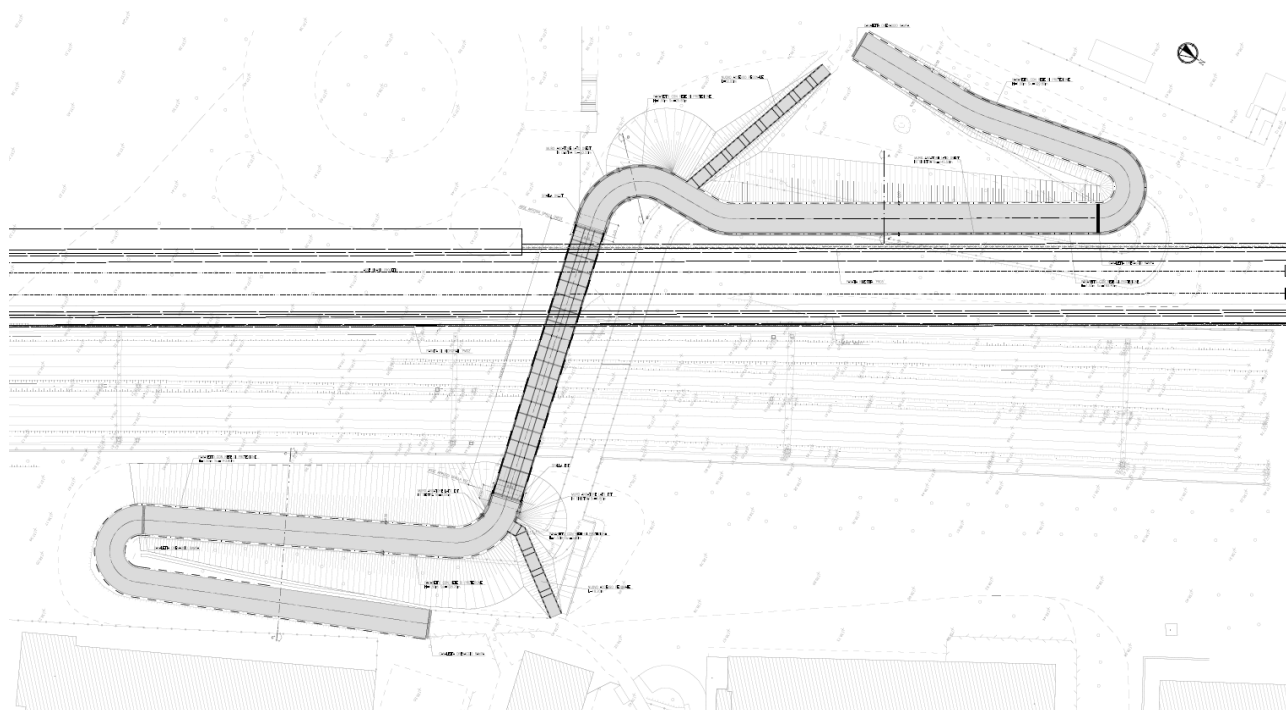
Planimetria passerella ciclopedonale con rampe di accesso.
